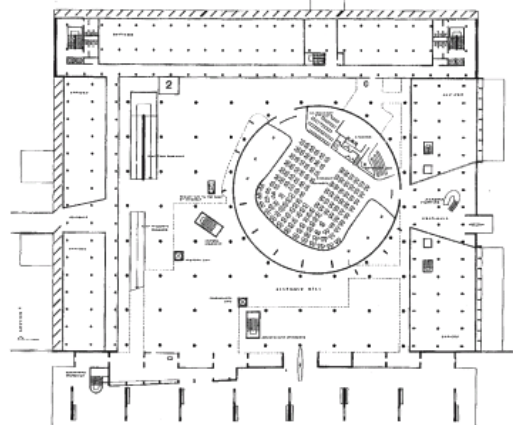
e 60 - Vista e planta do piso térreo do Palácio de Chandigarh
